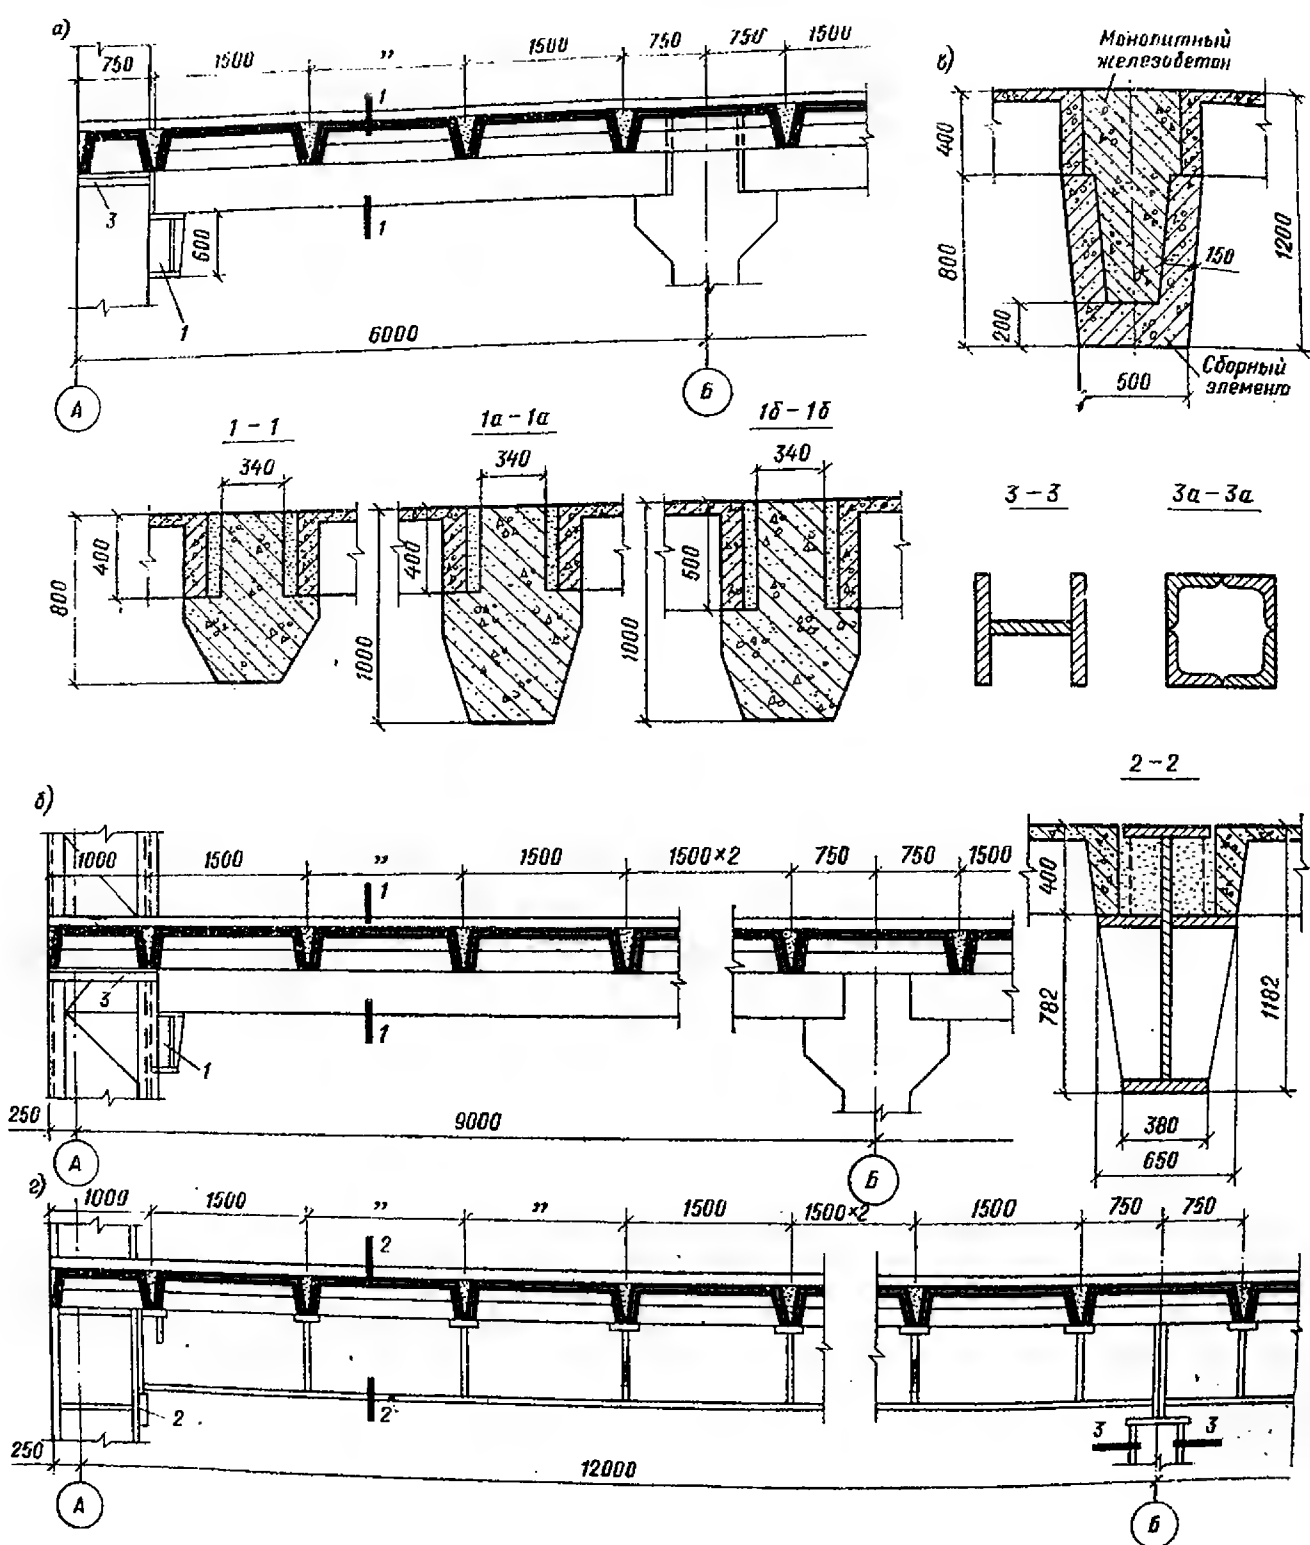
Конструкции междуэтажного перекрытия двухэтажных зданий
